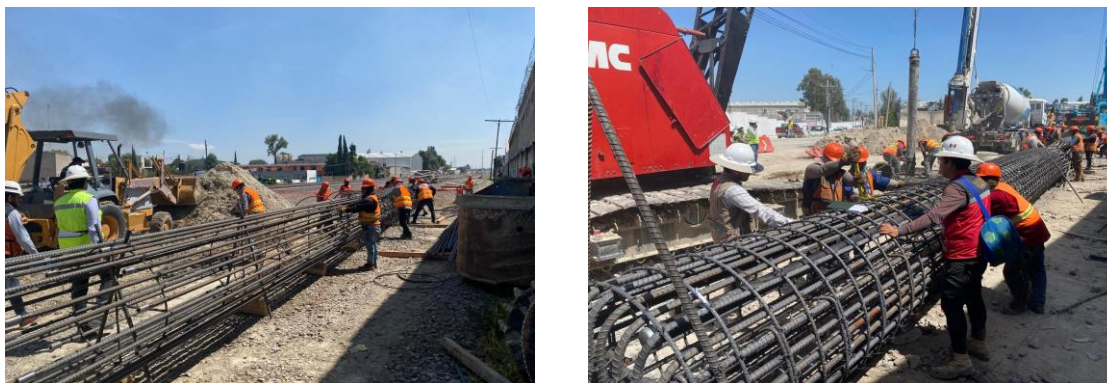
y 59 Autoría Propia (2023) "Vista de los inicios para el armado de acero en pila de cimentación y supervisión en campo del acoplamiento a través de conectores mecánicos"
